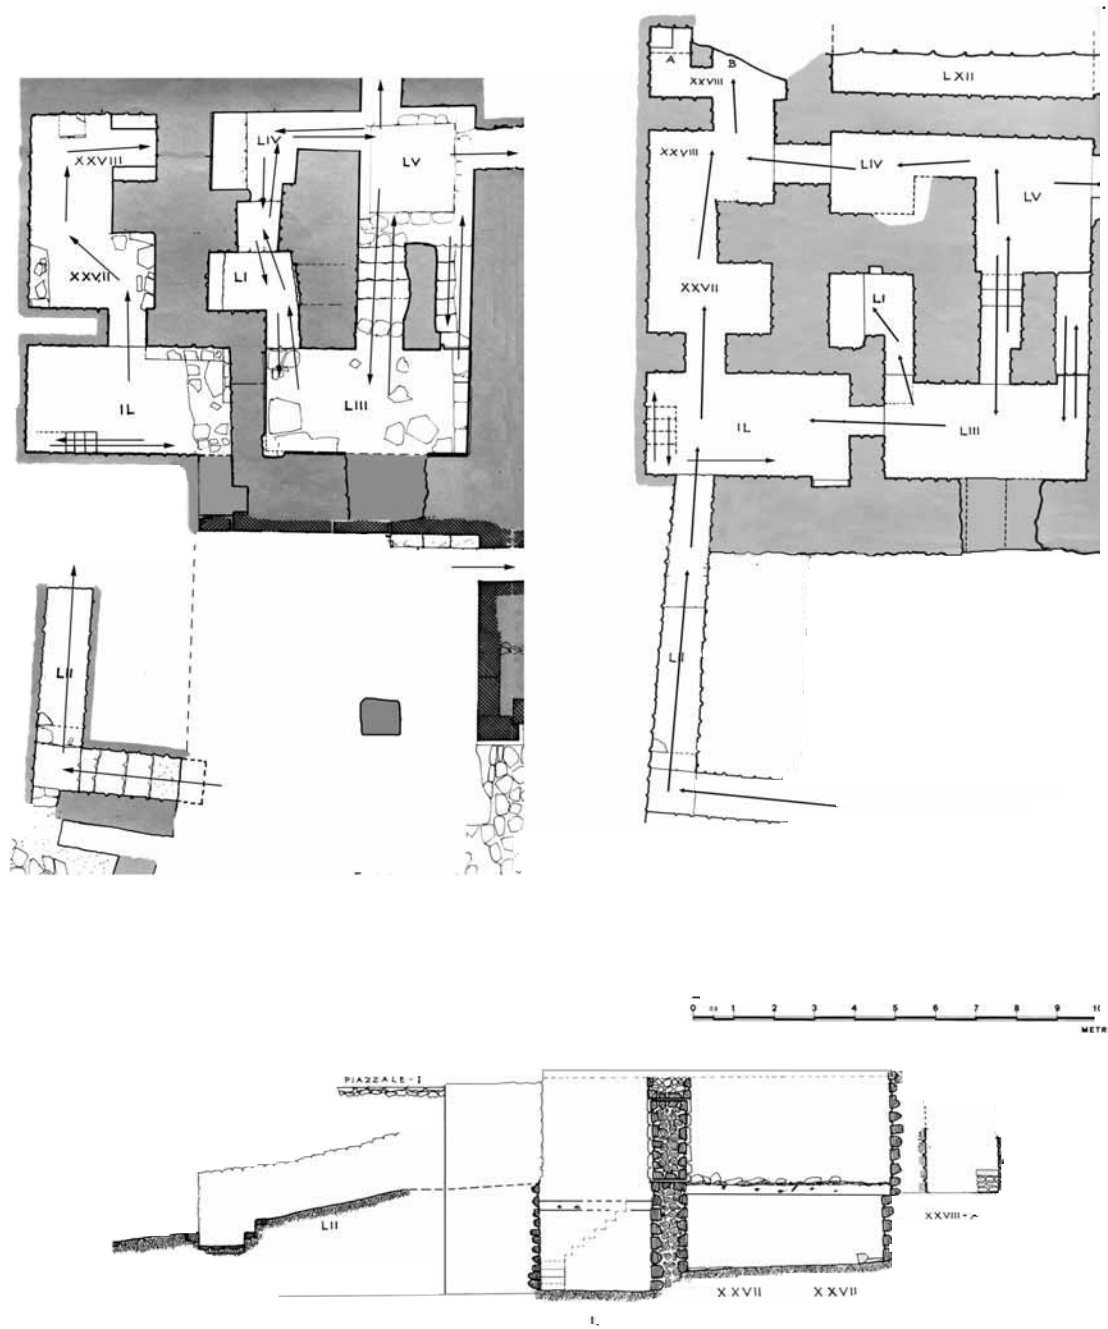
IPOTESI DI RICOSTRUZIONE E SCHEMA DI CIRCOLAZIONE INTERNA DEI VANI IL-XXVII-XXVIII NELLA FASE DELL’IMPIANTO ORIGINARIO (FASE DEL BETILO). A: PIANTA DEL PIANO TERRENO; B: PIANTA DEL PRIMO PIANO; C: SEZIONE EST-OVEST.
